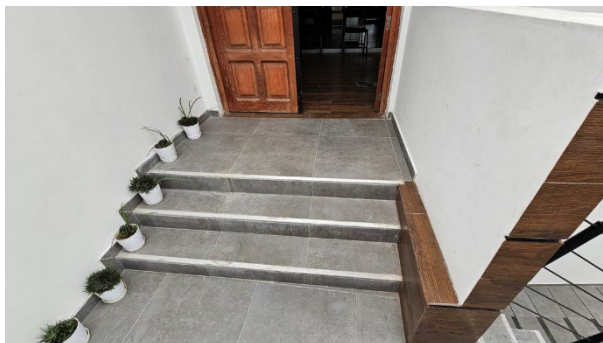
Nueva baranda metálica instalada en escaleras, reemplazando la existente que era de vidrio sobre estructura metálica.
